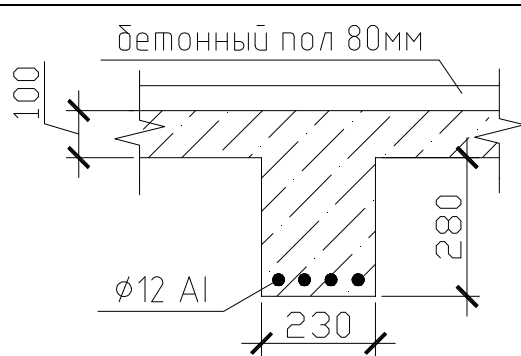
Главная балка ж/б перекрытия над вторым этажом в осях «3-б/В-Е»
